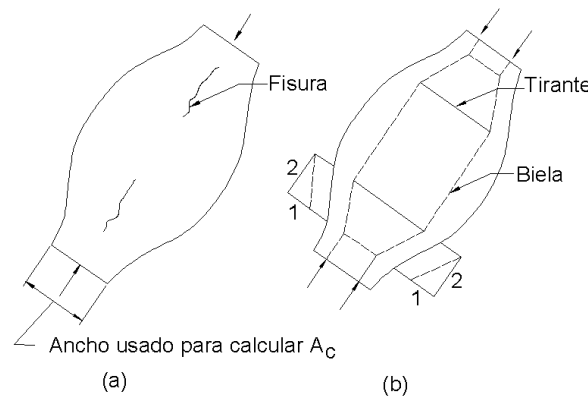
Fisuración longitudinal de una biela en forma de botella
